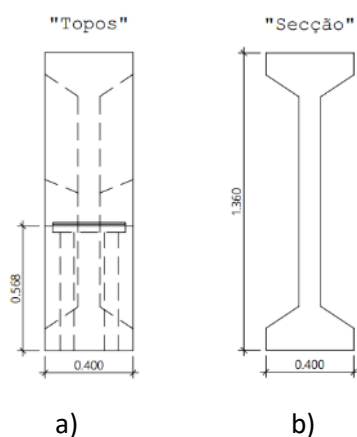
Viga de secção variável: a) Secção nos topos; B) Secção ½ vão.
